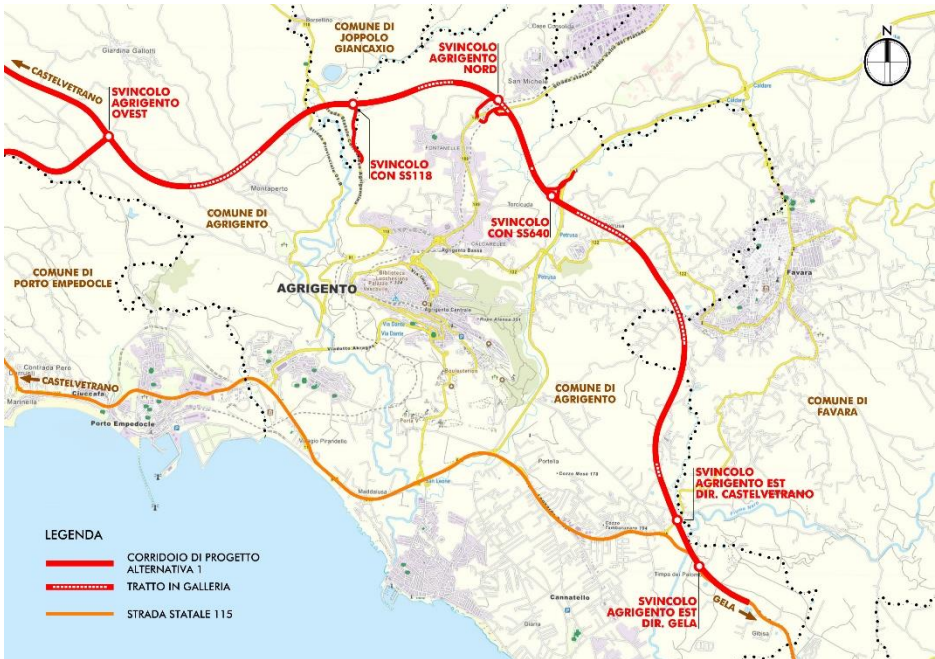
Alternativa 1: planimetria di progetto tratto est
